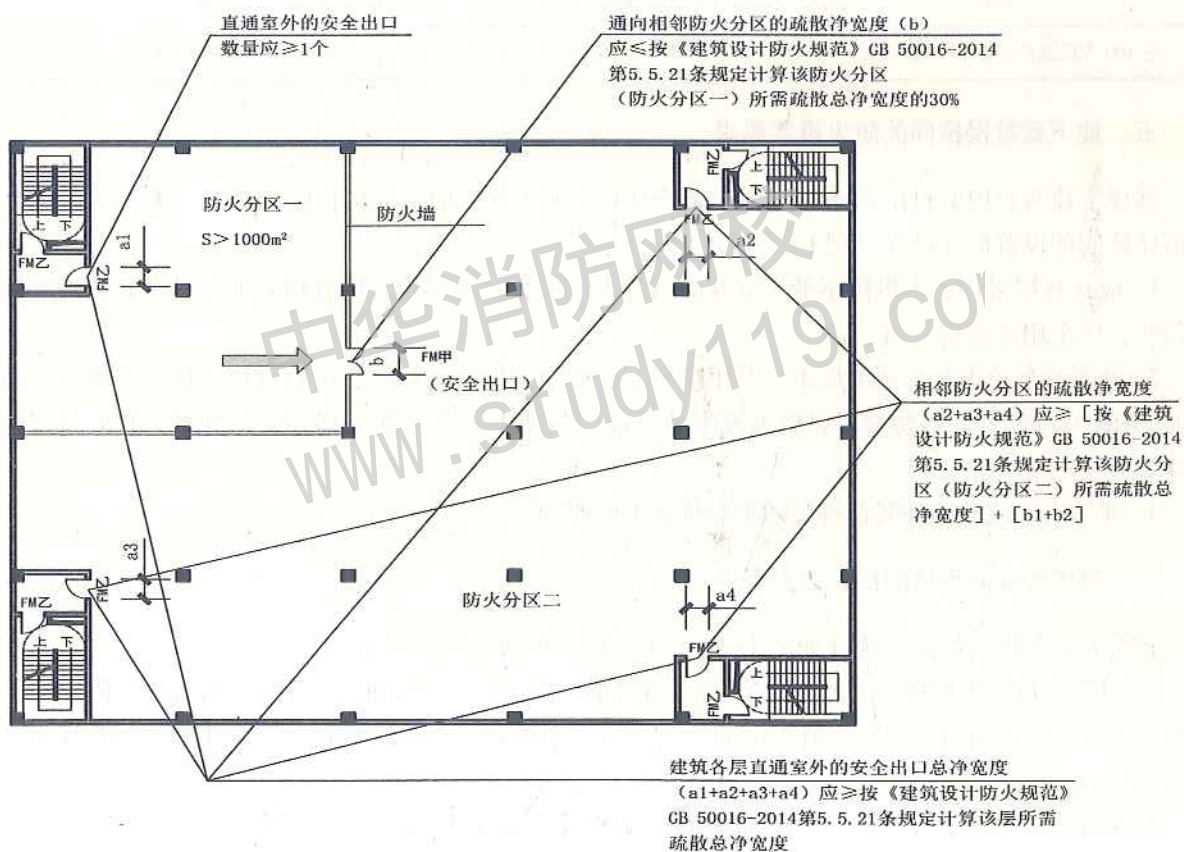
一、二级耐火等级公共建筑 建筑平面示意图
